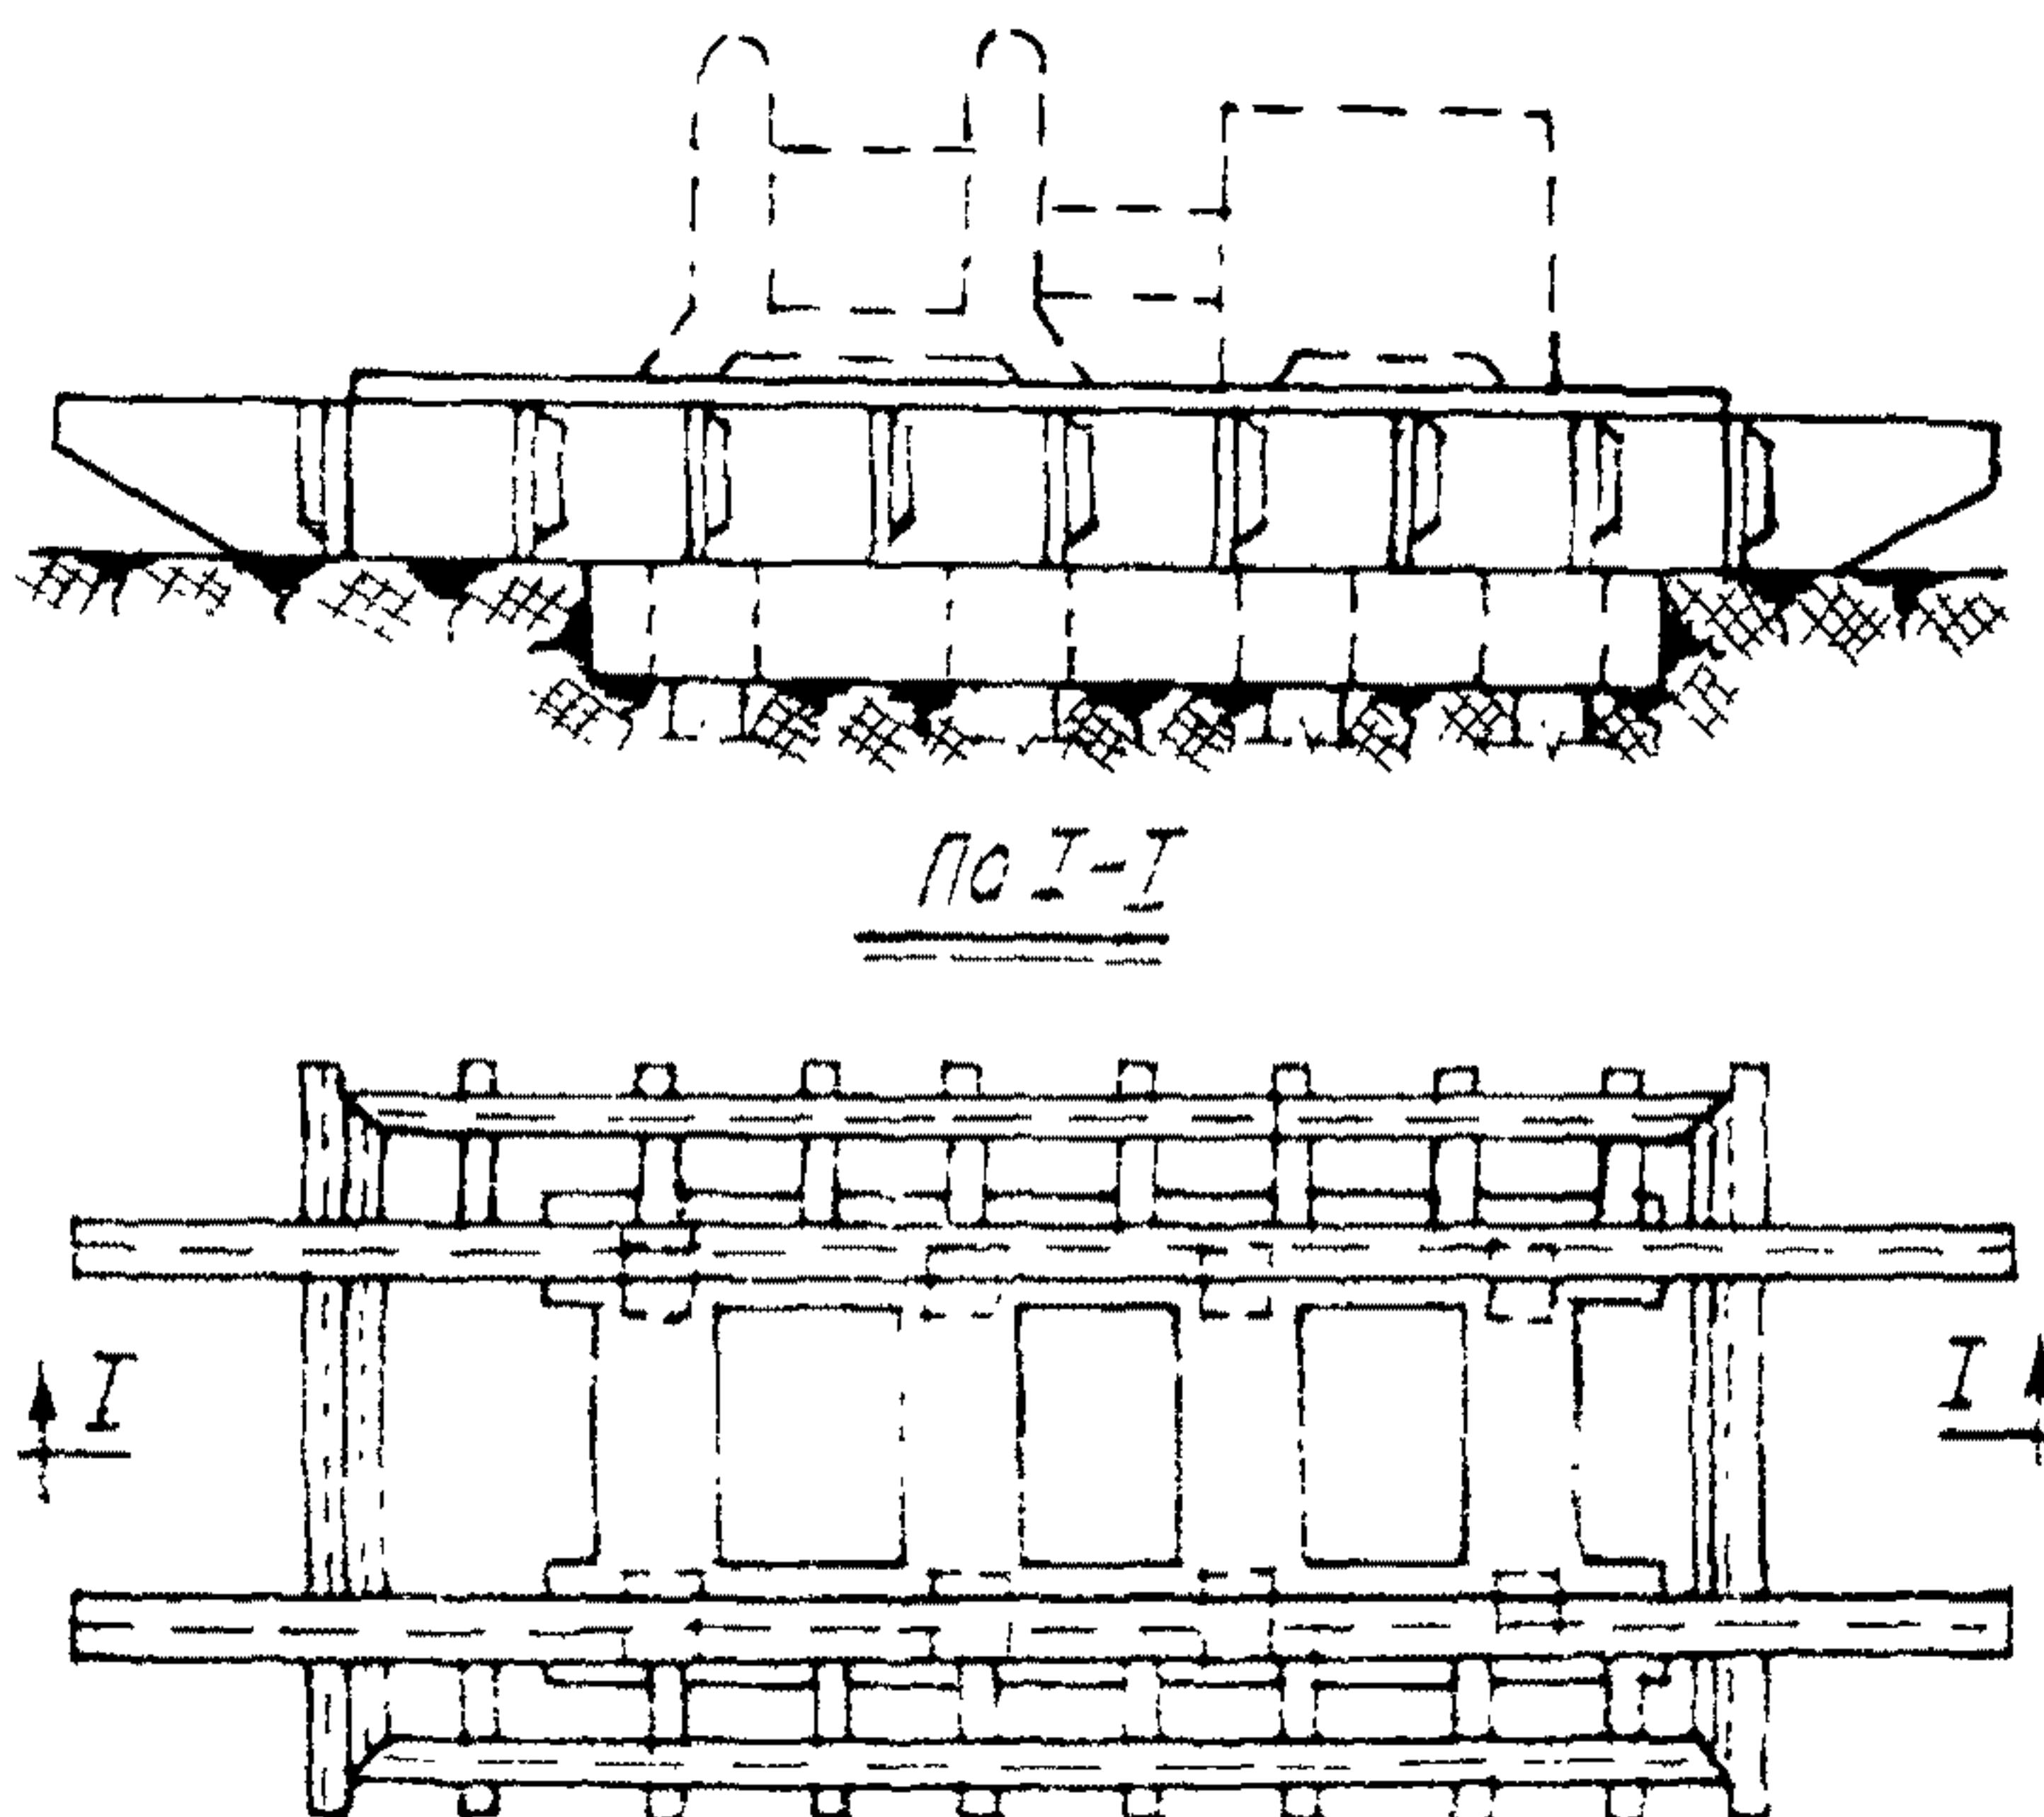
Установка блок-бокса на свайный фундамент с монолитным ростверком
